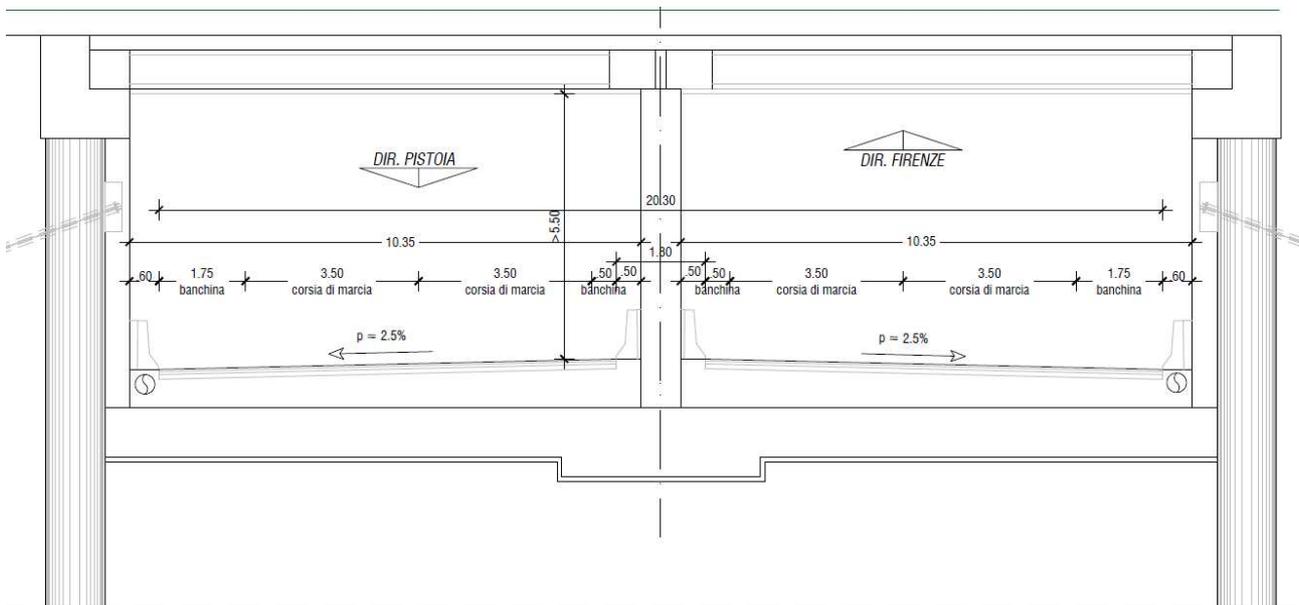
Sezione tipo "ASSE PRINCIPALE"
